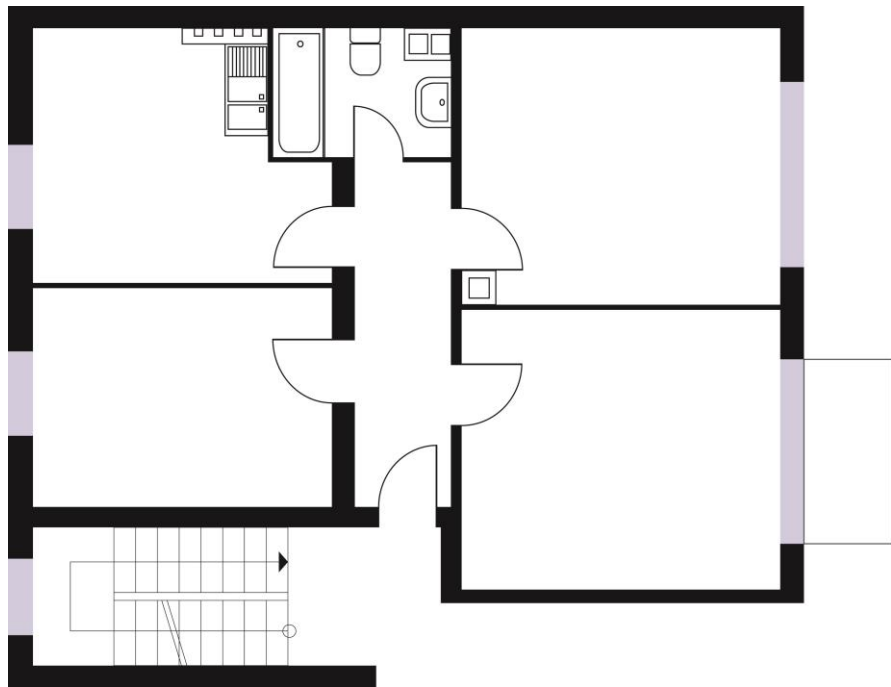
Vergrößerung eines Badezimmers durch Versatz einer Wand in Richtung Diele
